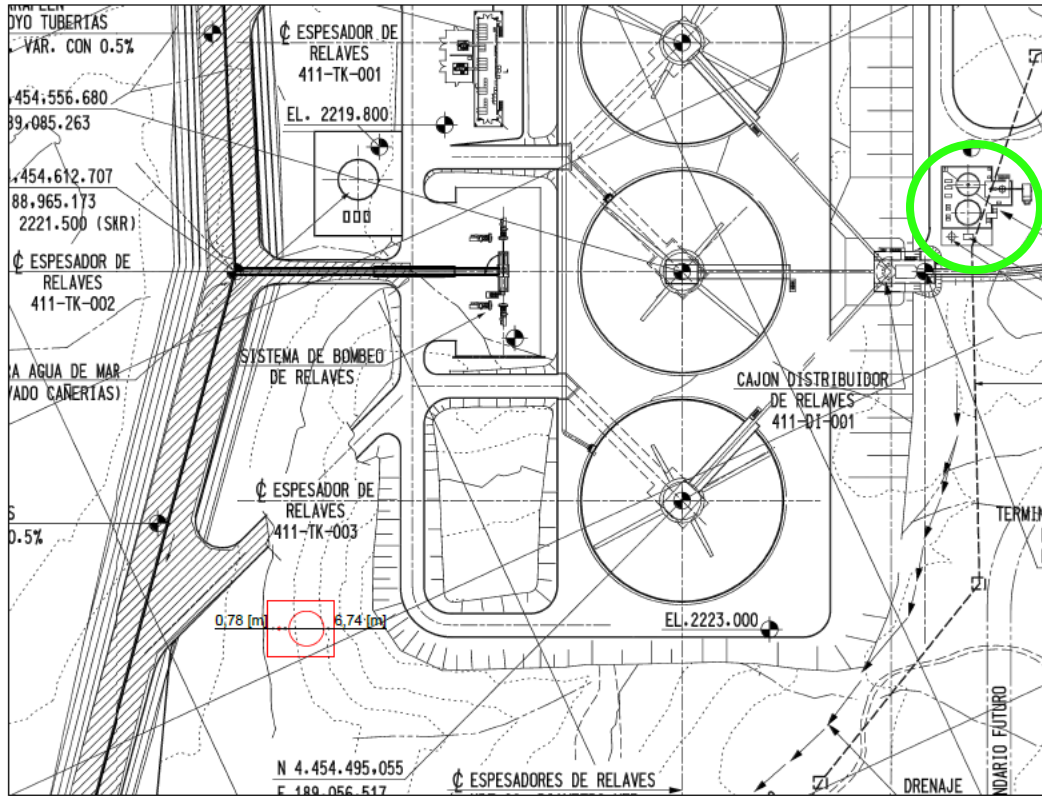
Instalaciones en faena para aditivo 1,5 y 6, considerando caso pequeño. En verde, planta de floculante.
